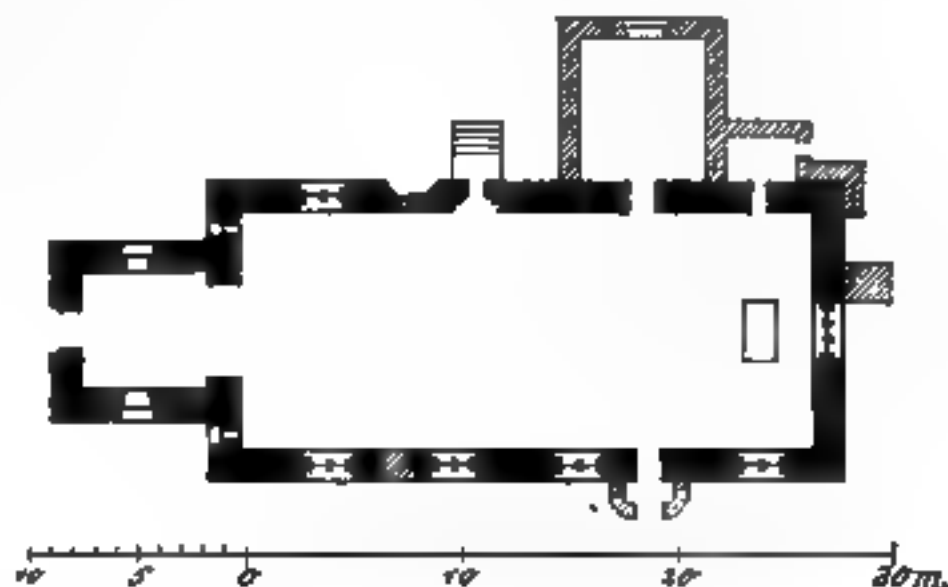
Grundriss der Kirche im Maßstabe von 1:300.
